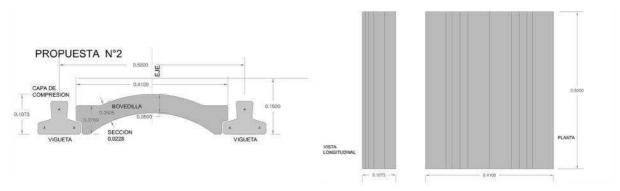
"Planta, vista longitudinal y sección de la propuesta Nº 2"
